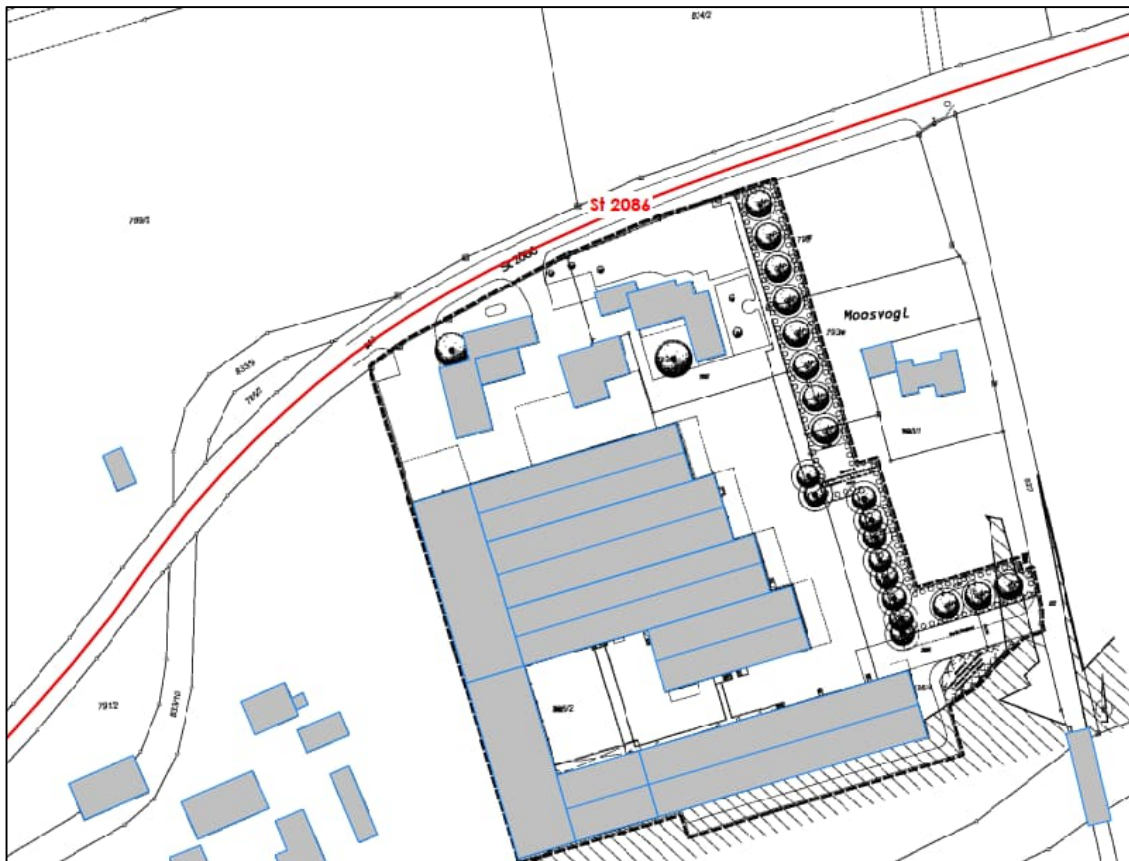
Lageplan mit Darstellung der relevanten Schallquelle zur Ermittlung der Straßenverkehrslärmimmissionen
